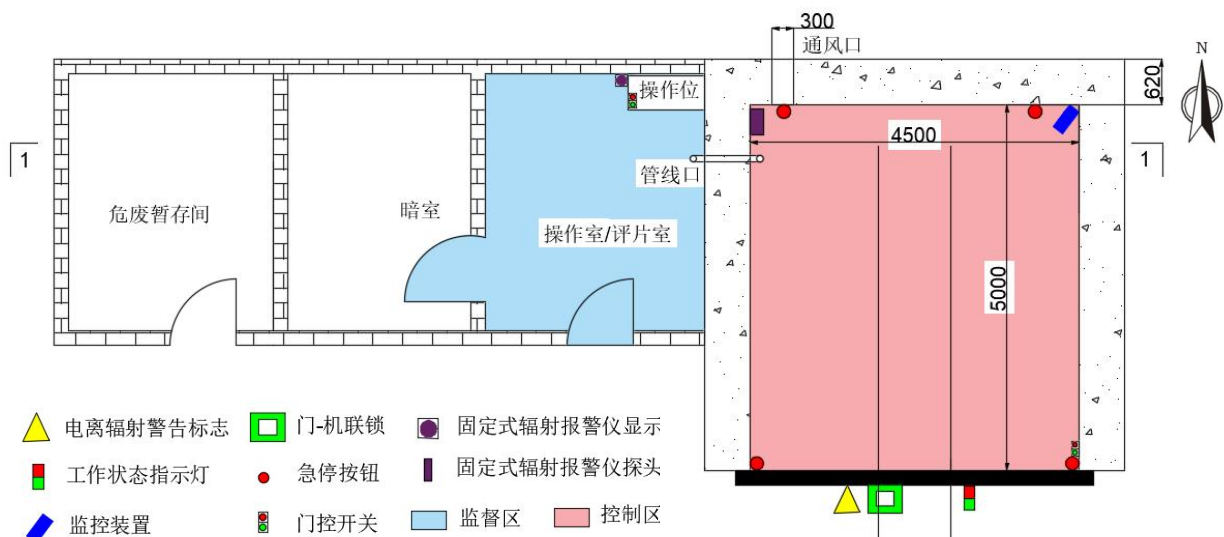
(a) 本项目探伤室平面布置图 (mm)
